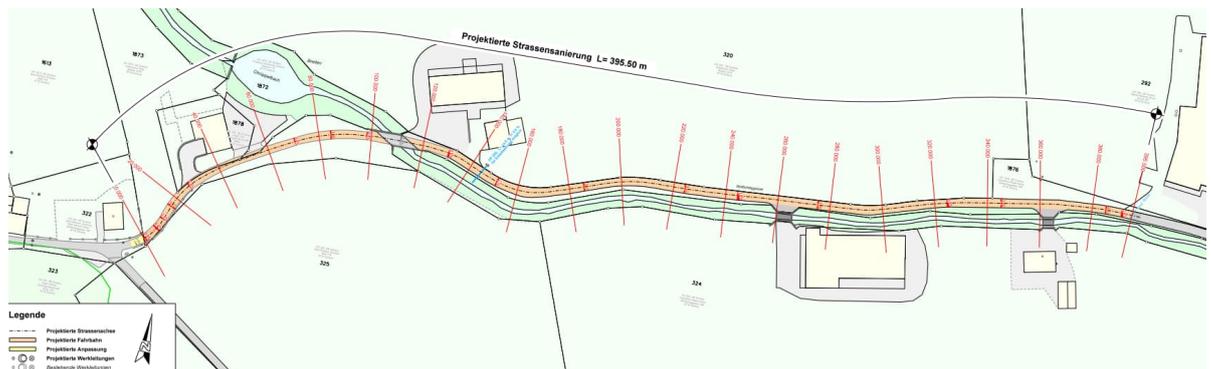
Ausschnitt Situation Projektierte Erschliessungsstrasse, Plan Nr. 1357-012
